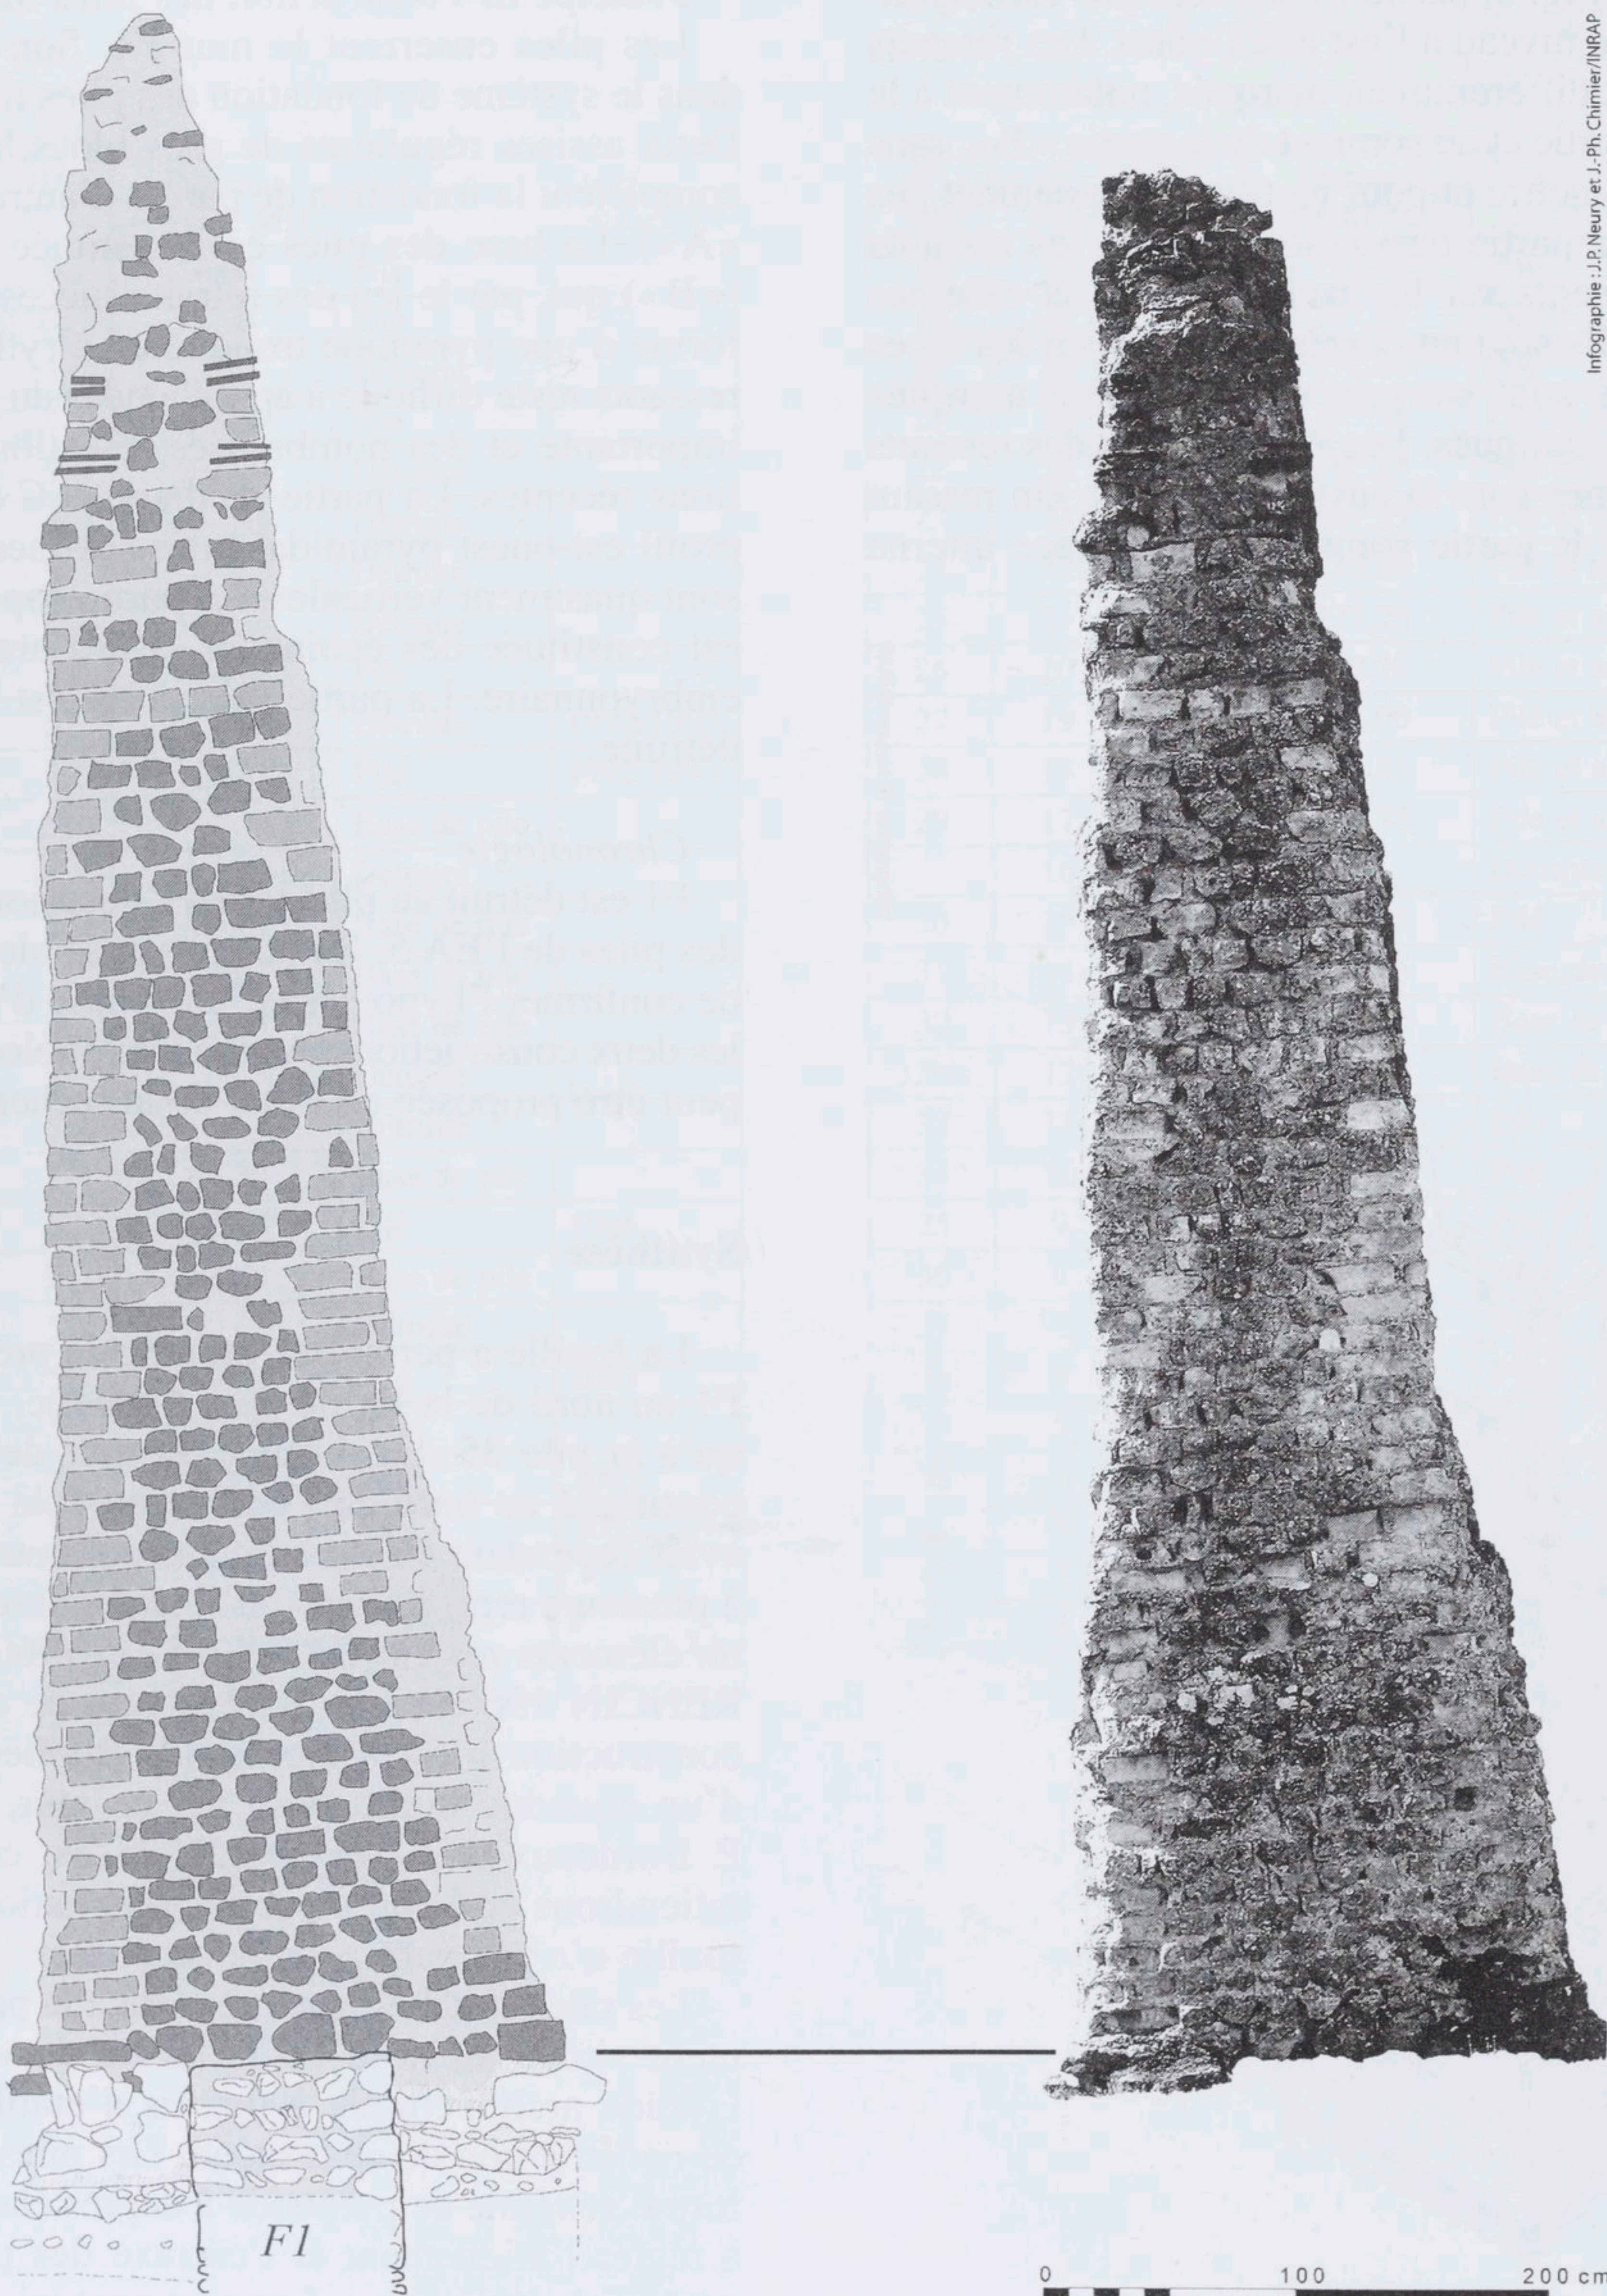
Élévation de la face Nord de la pile 35 (dessin P. Neury, INRAP).
